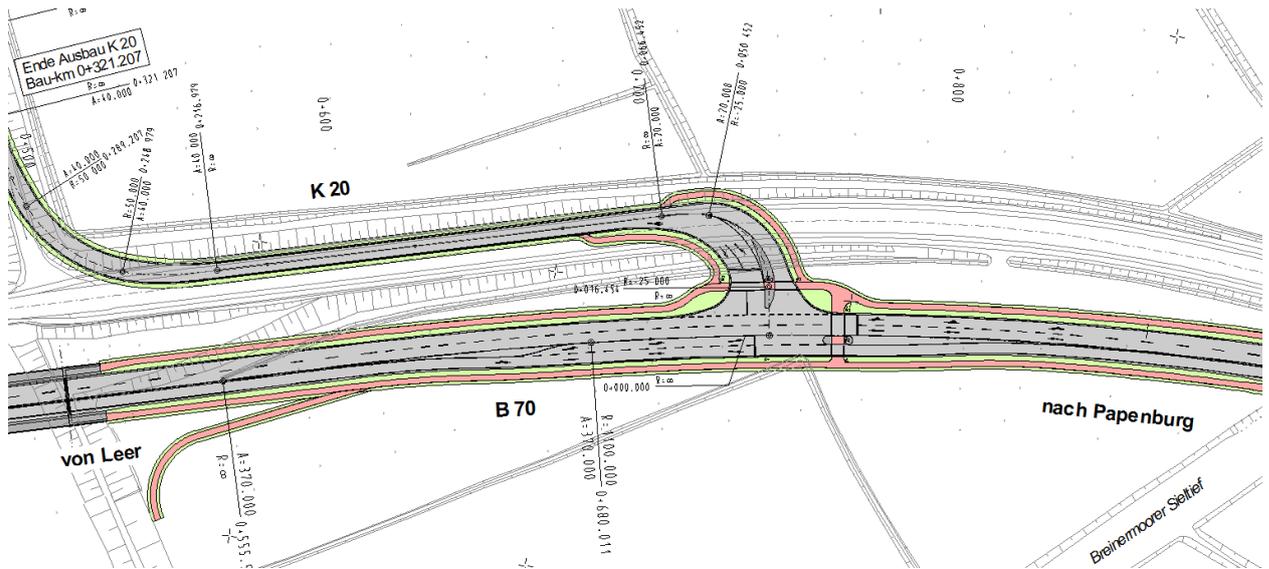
Planausschnitt Knotenpunkt B 70 / K 20 Ausbauplanvariante 3
